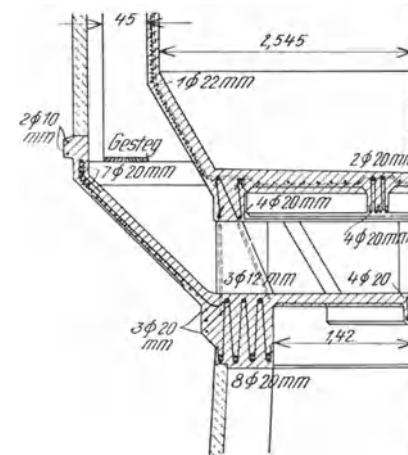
Einzelheiten von einem Eisenbetonwasserbehälter mit ebenem Boden. (Nach Hdb. f. Eisenbetonbau, Bd. 5)
